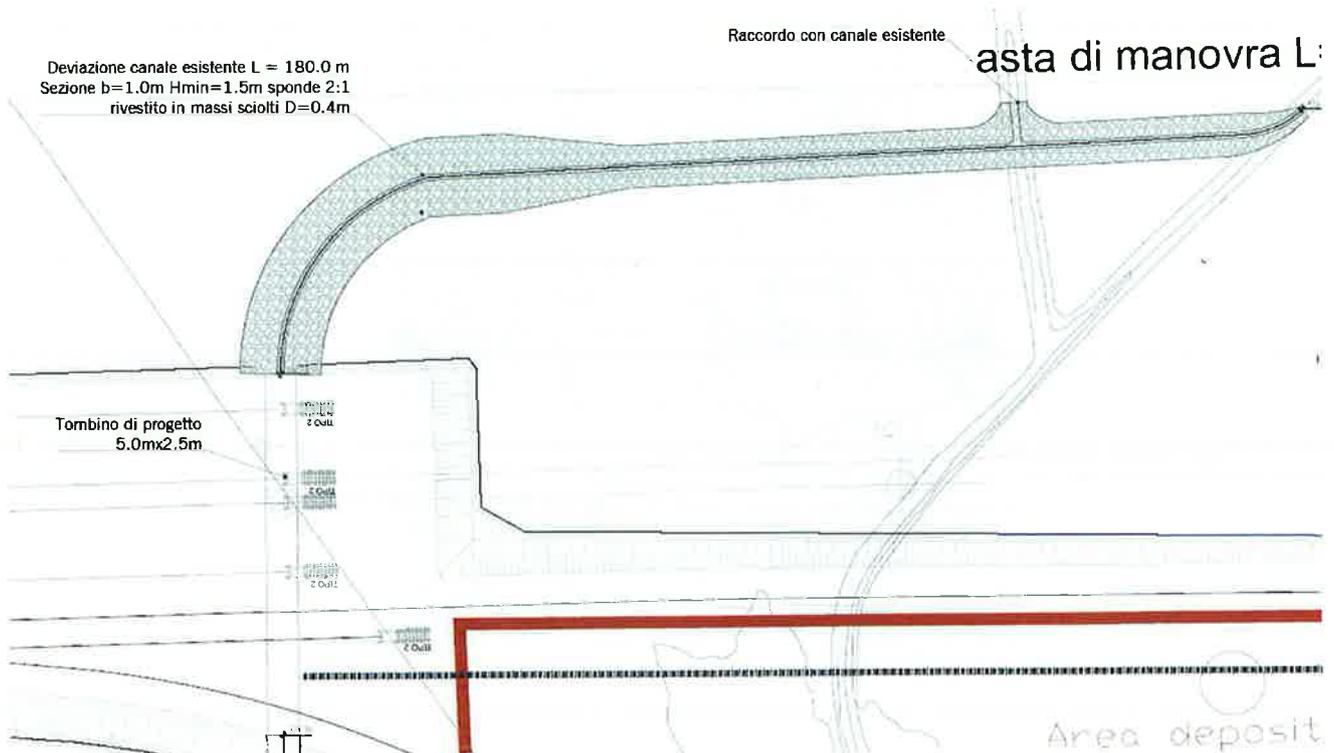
Inalveazione IN01 – tratto a monte della linea ferroviaria. Pianta
